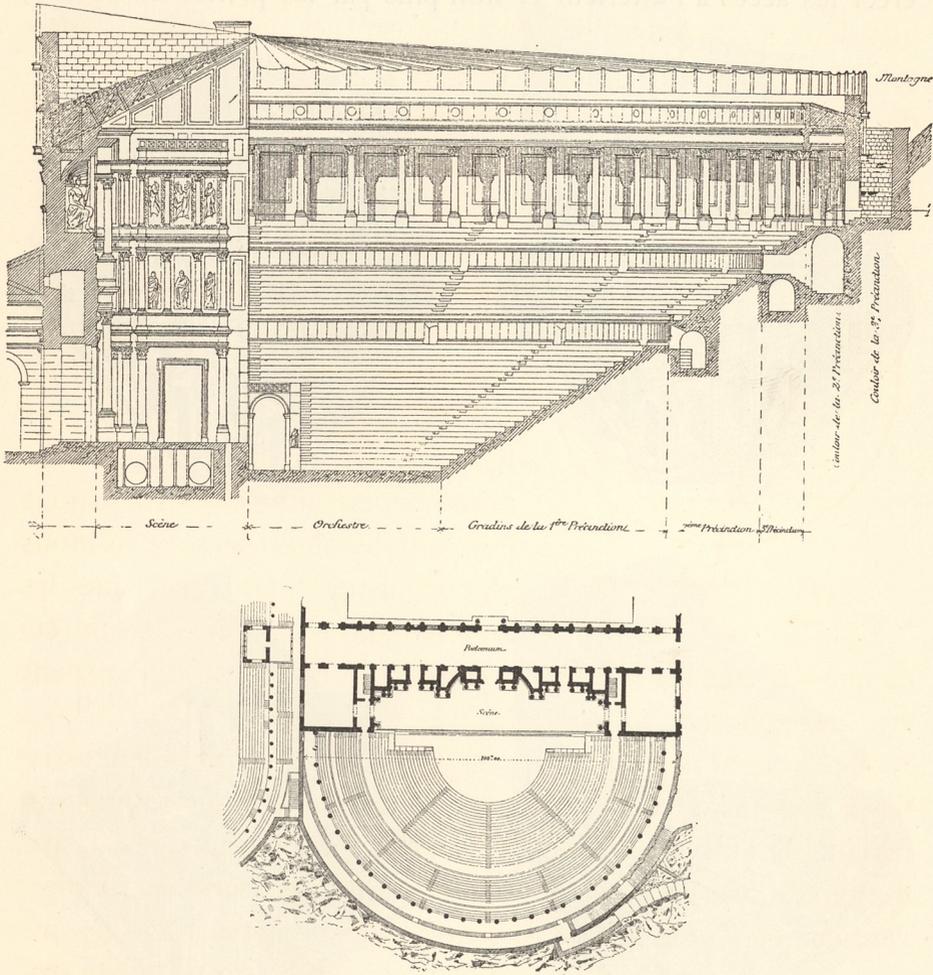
Théâtre d'Orange. Coupe et plan.
